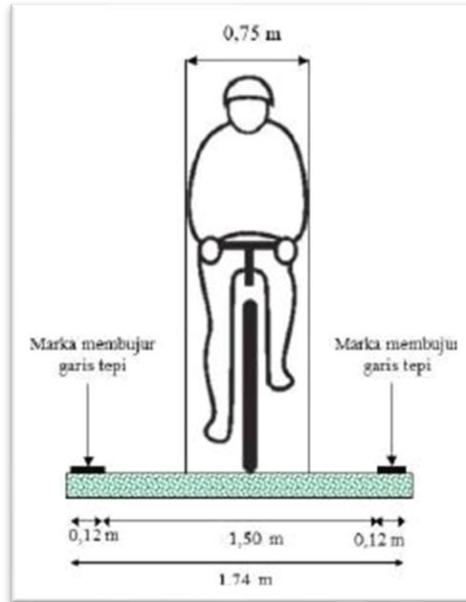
Lebar Minimum Satu Lajur Sepeda
